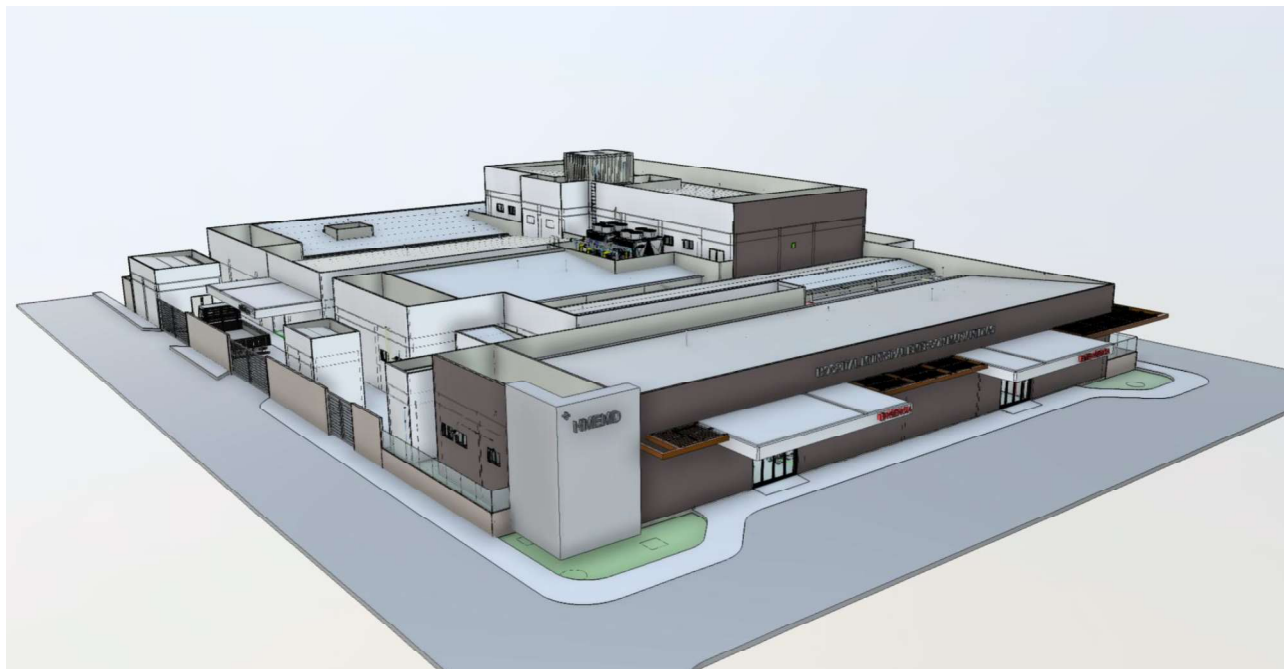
Modelo Federado – Arquitetura + Estruturas+ Instalações Prediais
